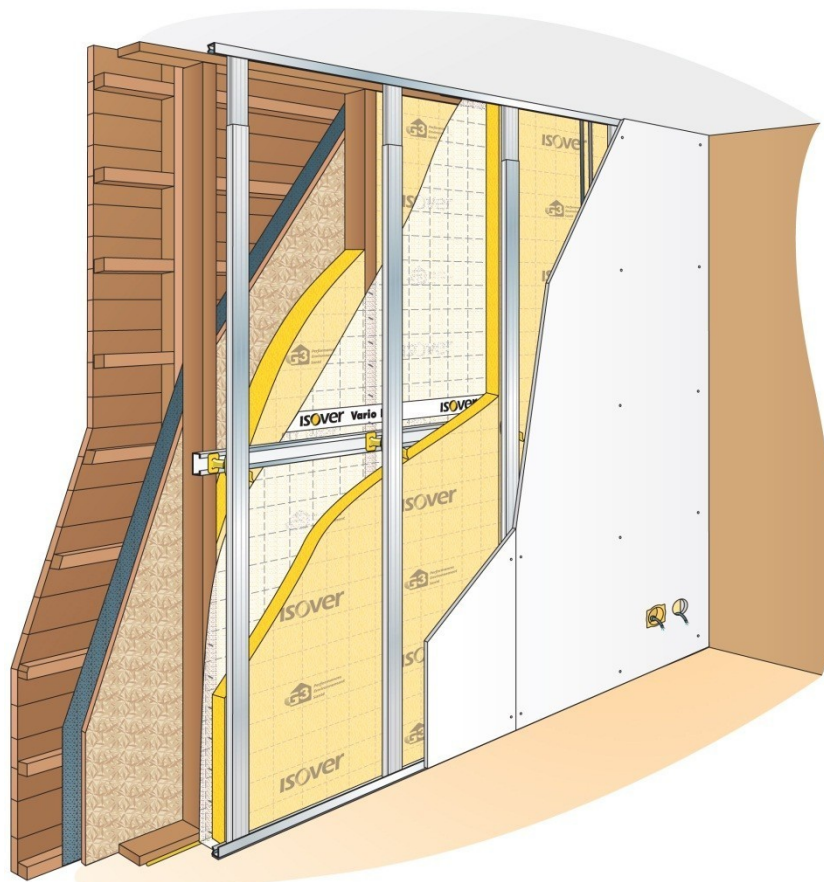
Pose de la membrane d'étanchéité à l'air entre les deux couches d'isolant
